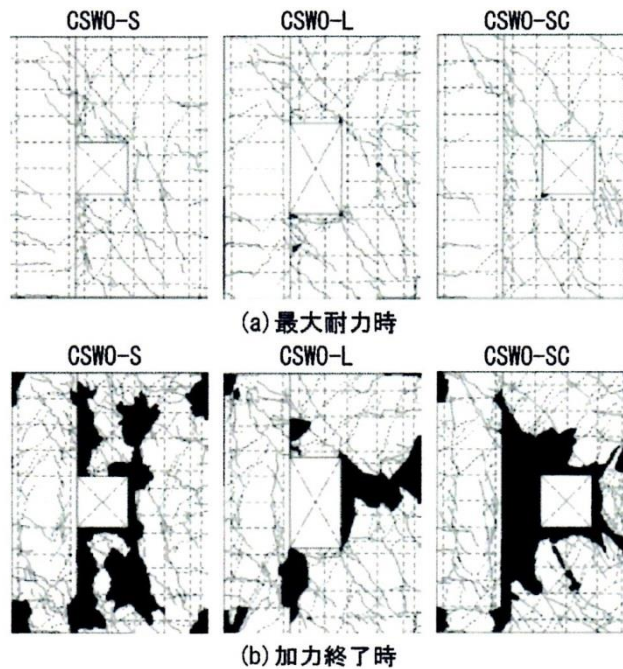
ひび割れ図<sup>27)-29)</sup>
